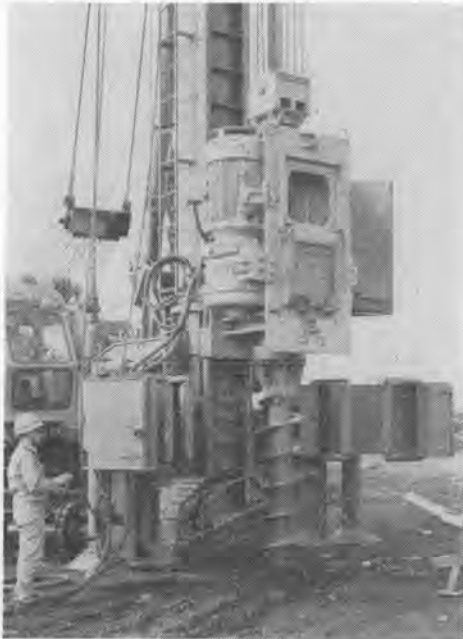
止水効果の高い地下連続壁 A-LAP 工法の施工要領図
